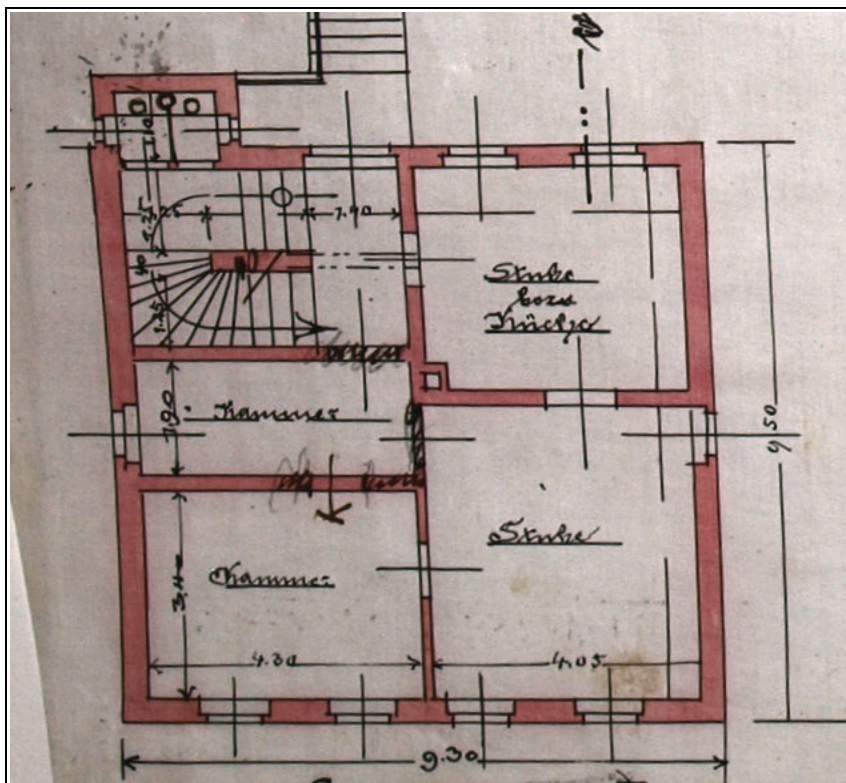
Grundriss Erdgeschoss ZFH
